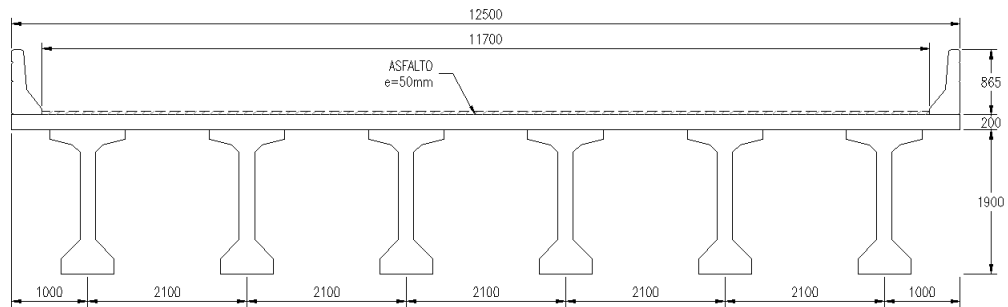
Vista de la sección transversal para el diseño de la losa.
